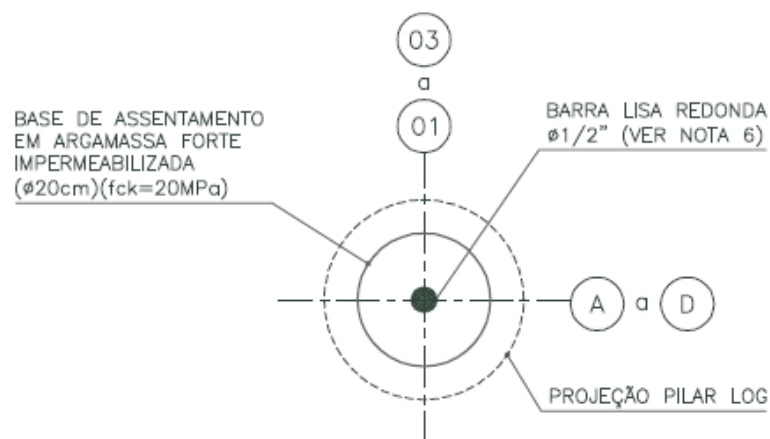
Planta baixa da base do pilar. Projeto cedido pela EMPRESA B.
